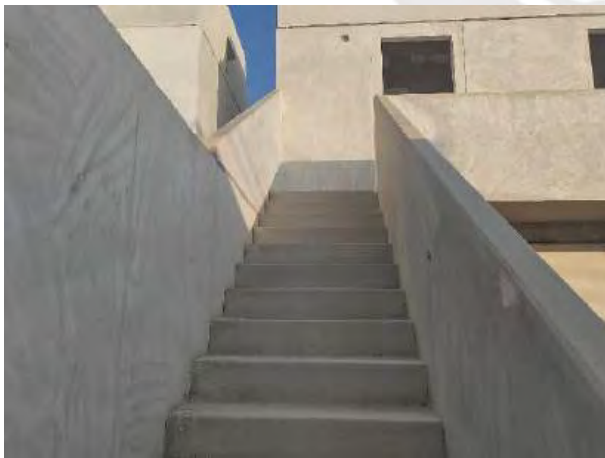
Urb. Buenavista – Casa Gardenia (1)
